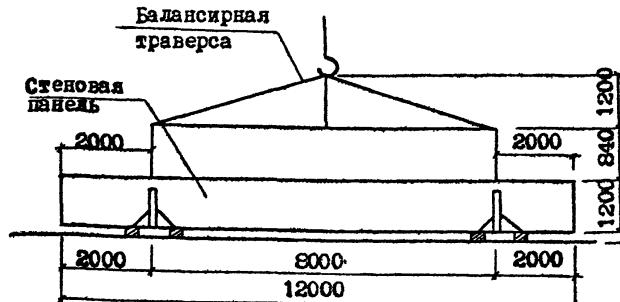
Строповка стенной панели при разгрузке и монтаже.
